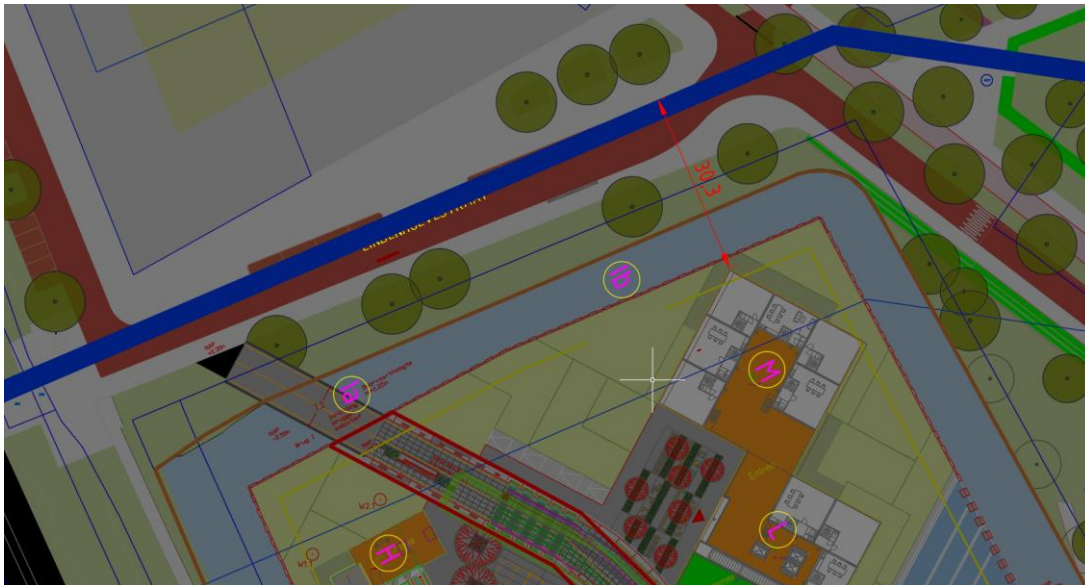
Uitsnede ligging waterkering ter hoogte van het plangebied Bajes Kwartier, rode lijn is grens plangebied Bajes Kwartier
